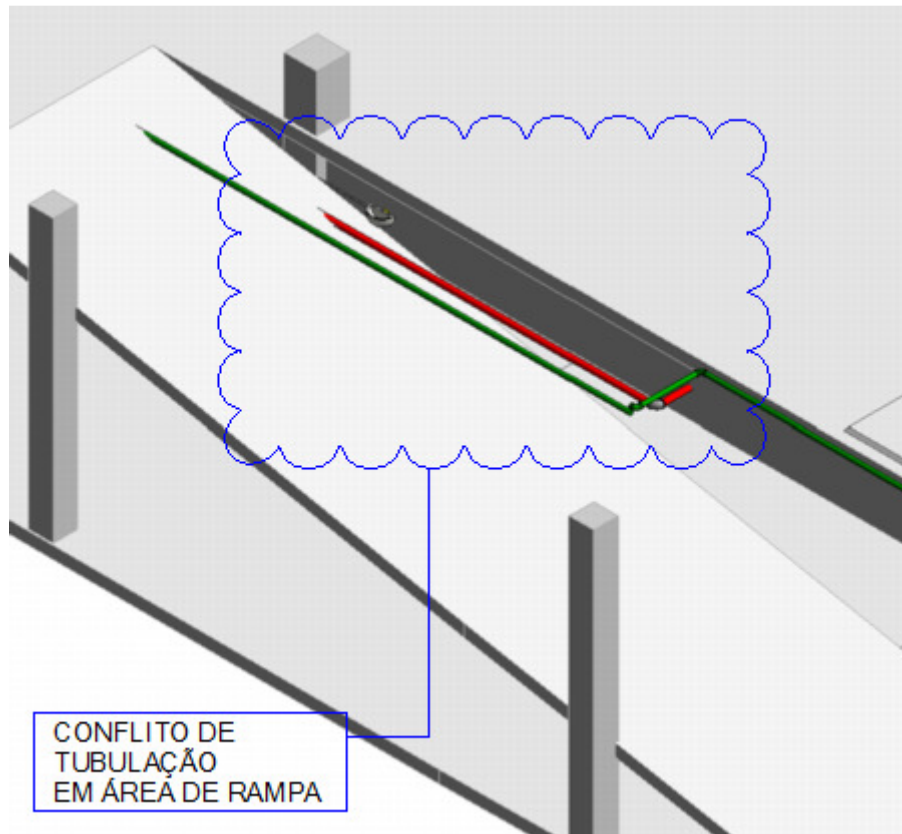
Relatório de Compatibilização DWF - Planta baixa tubulação 2º pavimento subsolo Anteprojetado.
